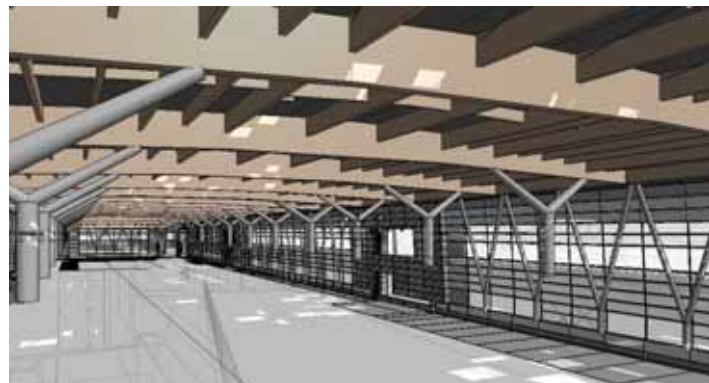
Stralcio modellazione 3D vista interna strutture e facciate in ambiente BIM
